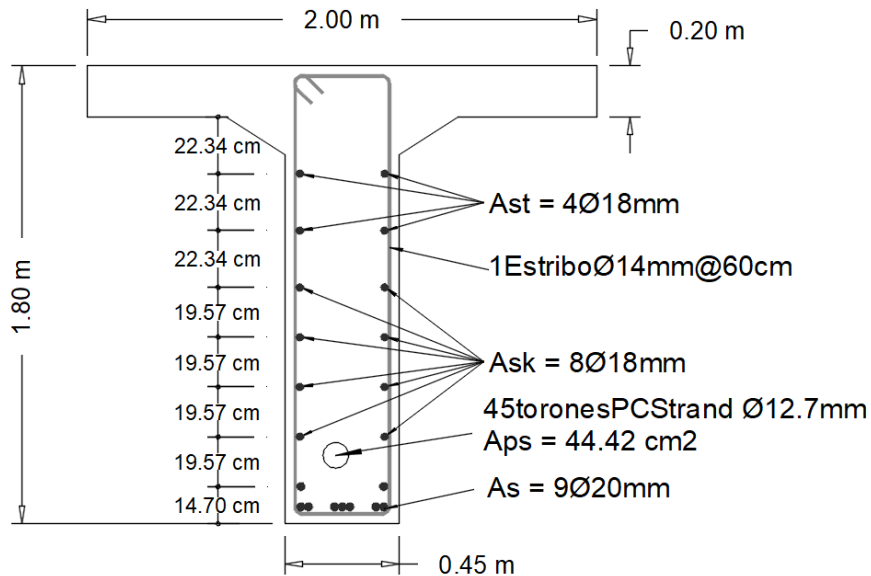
Sección de las vigas exteriores en la variante de vigas de hormigón postensado
